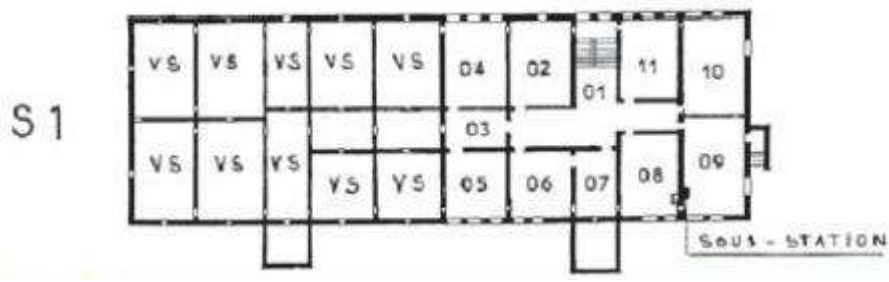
plan actuel des vides sanitaires et caves du bâtiment n°32
